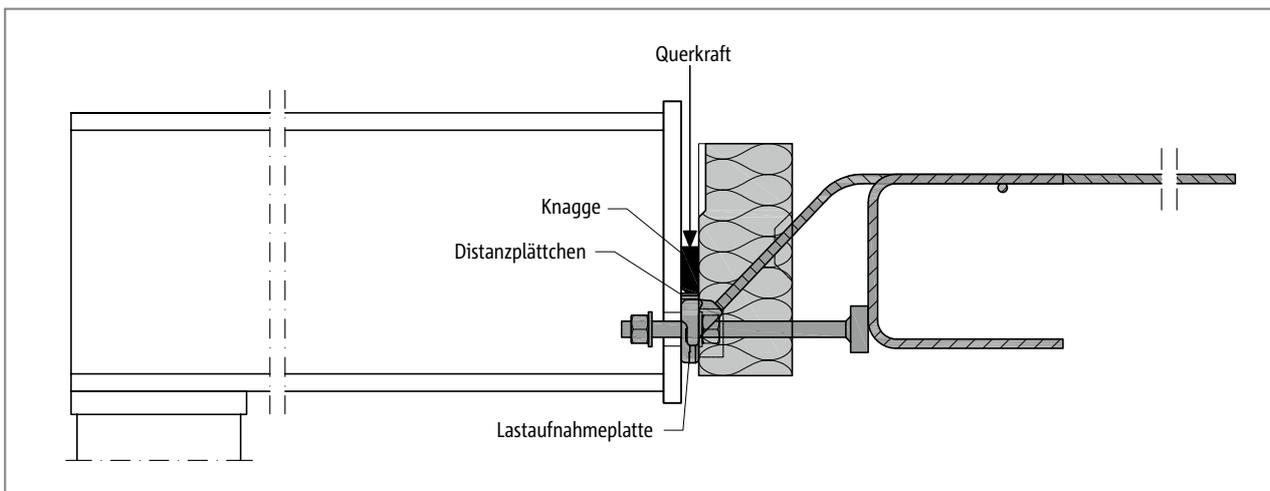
Schöck Isokorb® T Typ SQ: Bauseitige Knagge zur Übertragung der Querkraft
